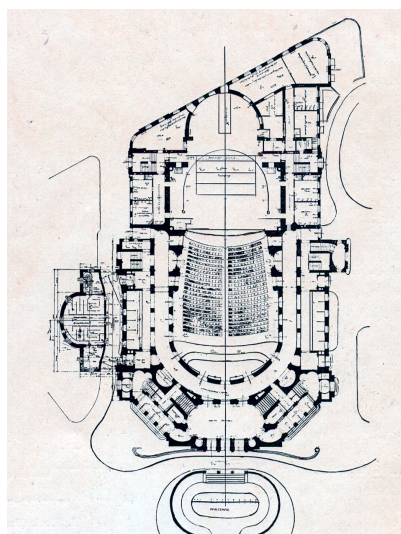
Deutsches Volkstheater, Grundriss Erdgeschoß
